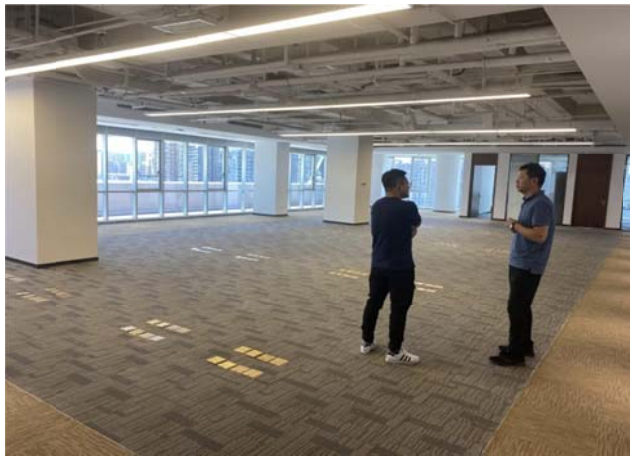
Despacho preexistente. Futuro despacho de Cancillería.
